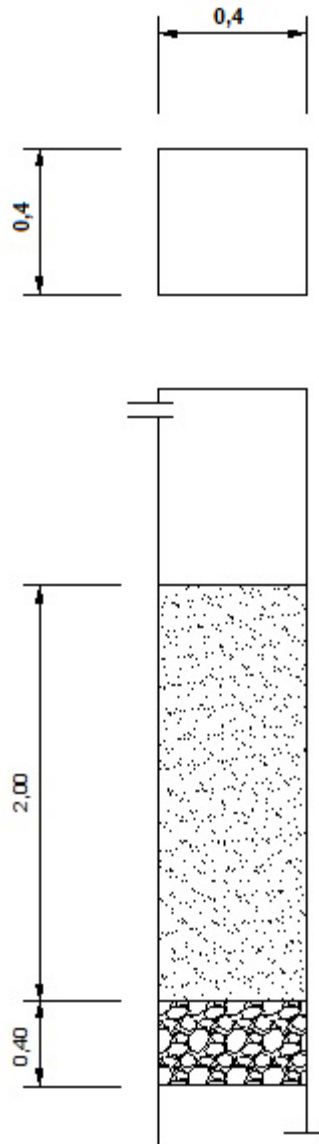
Corte e planta do filtro de camada simples (medidas em metros)
